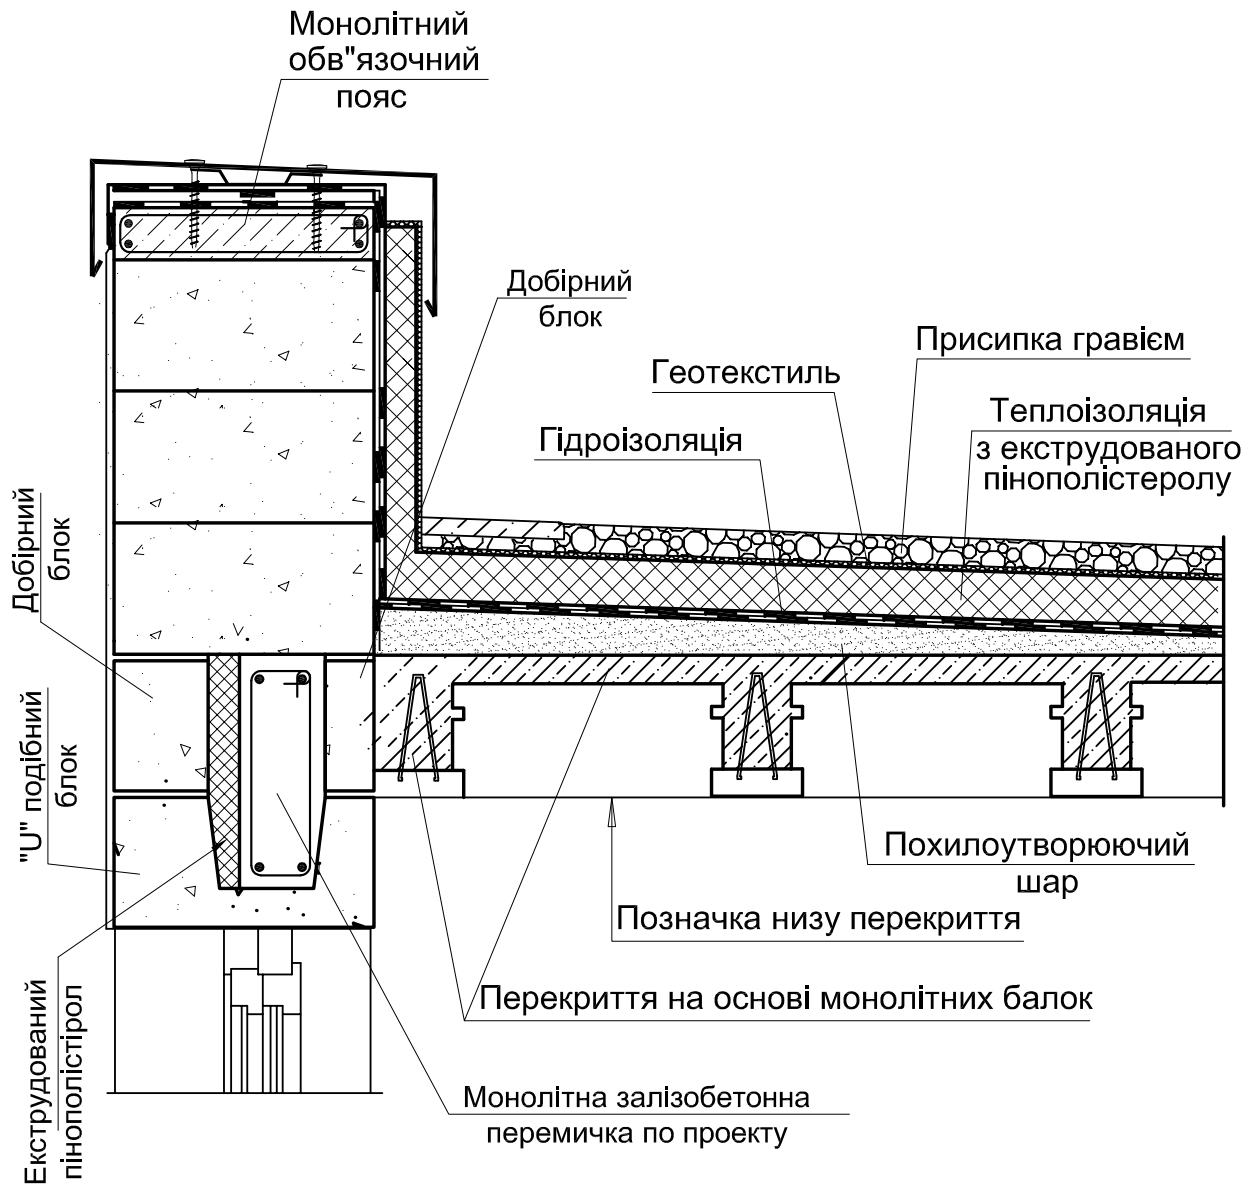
Конструювання утепленого плоского даху над збірно-монолітним дрібноштучним перекриттям даху. Проекція поперек несучих балок
